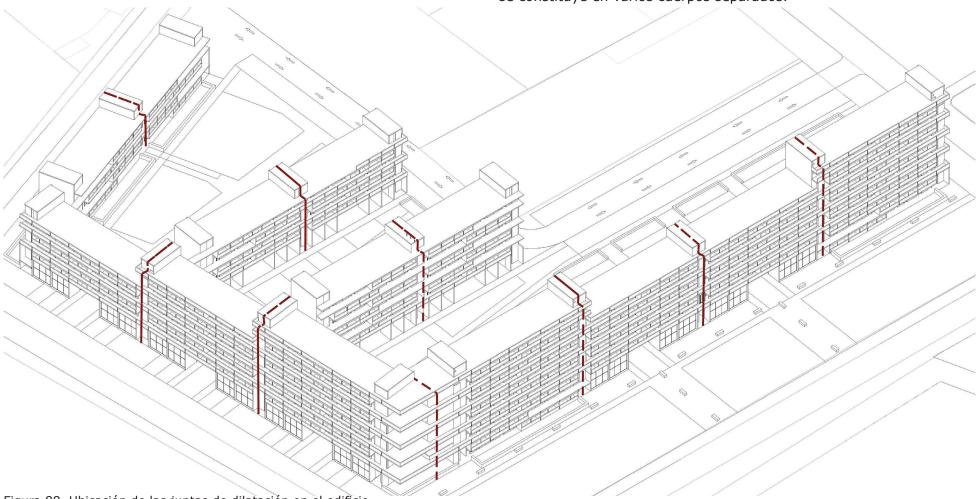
Ubicación de las juntas de dilatación en el edificio.
